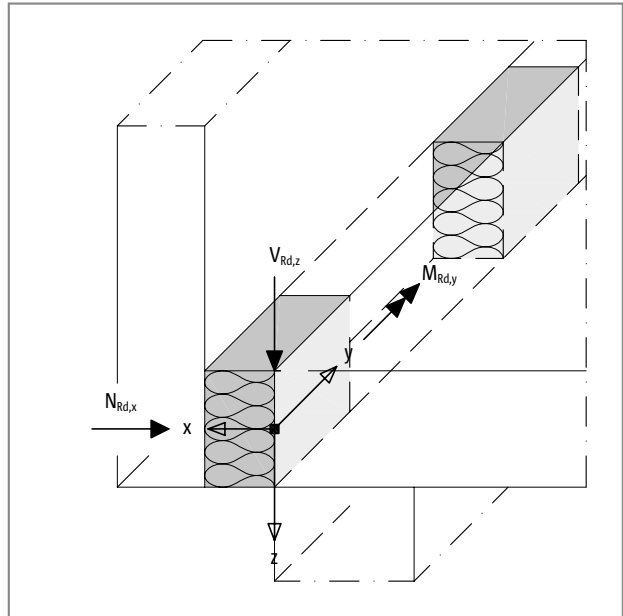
Schöck Isokorb® T Typ AP Vorzeichenregel für die Bemessung von vorgesetzten Brüstungen
